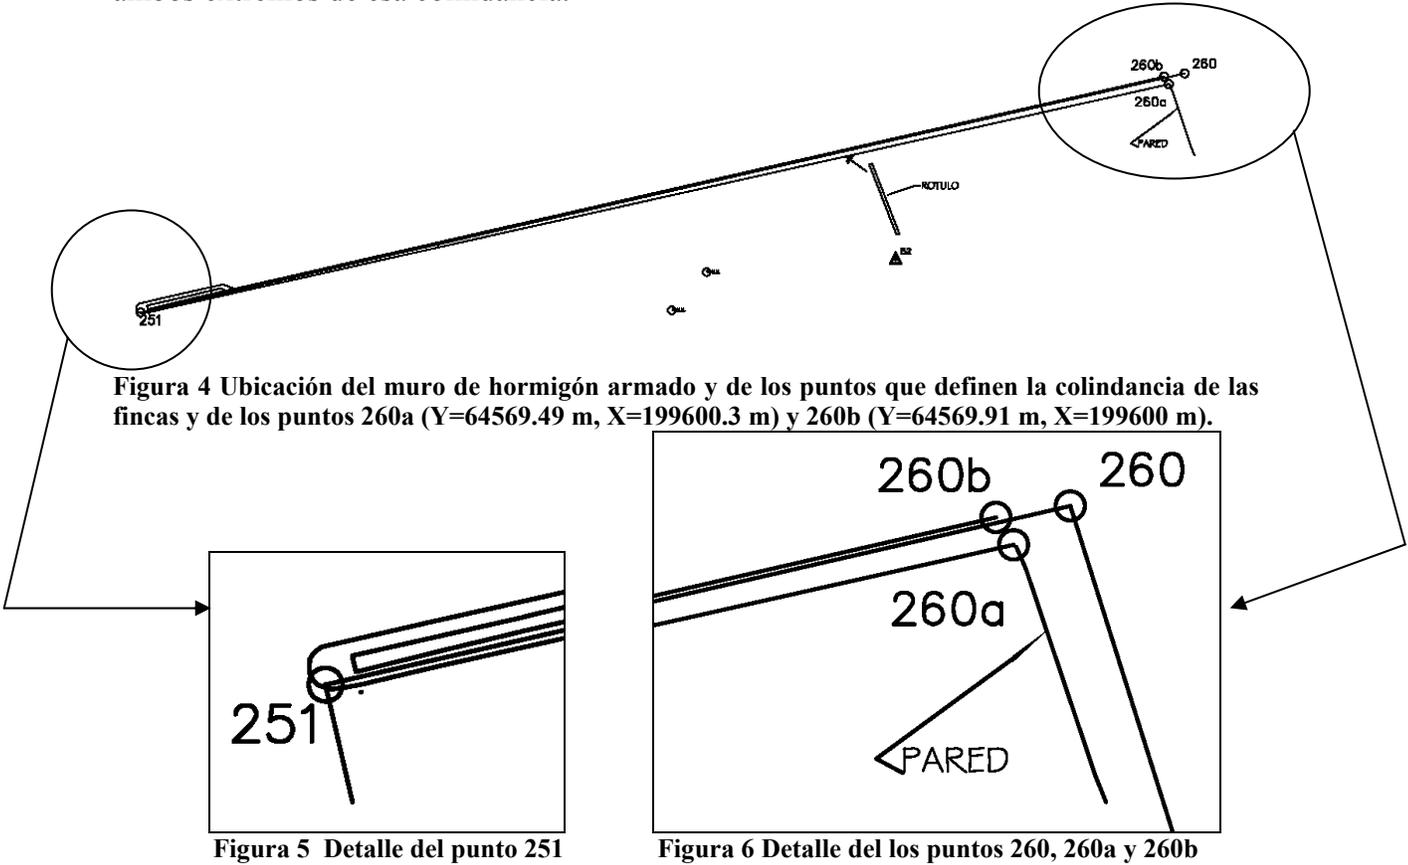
Ubicación del muro de hormigón armado y de los puntos que definen la colindancia de las fincas y de los puntos 260a (Y=64569.49 m, X=199600.3 m) y 260b (Y=64569.91 m, X=199600 m).
